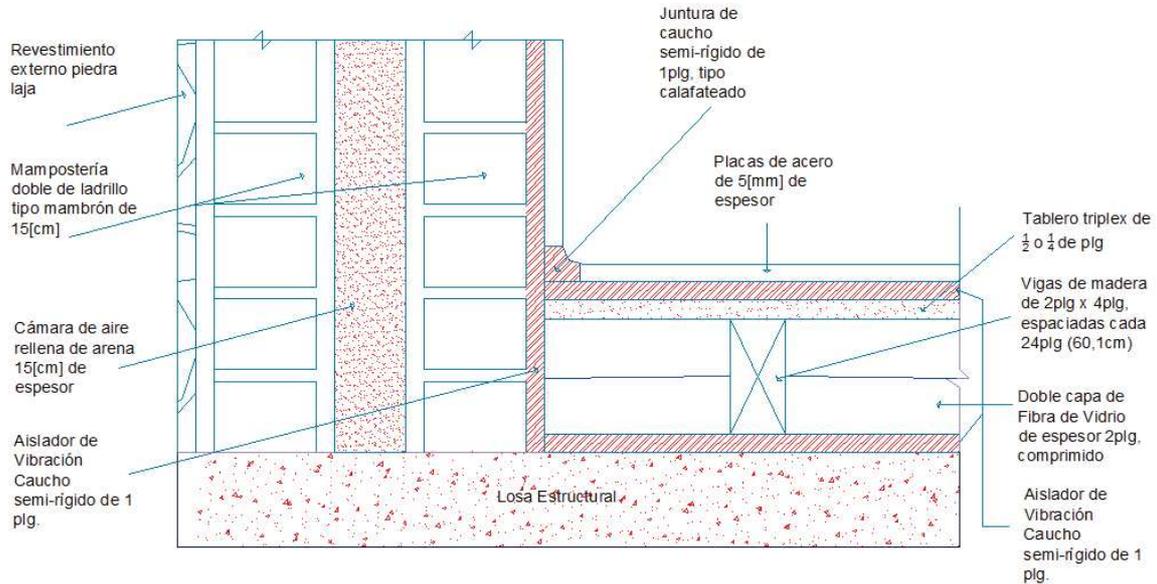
Aislamiento propuesto para paredes y piso de la cámara reverberante.
